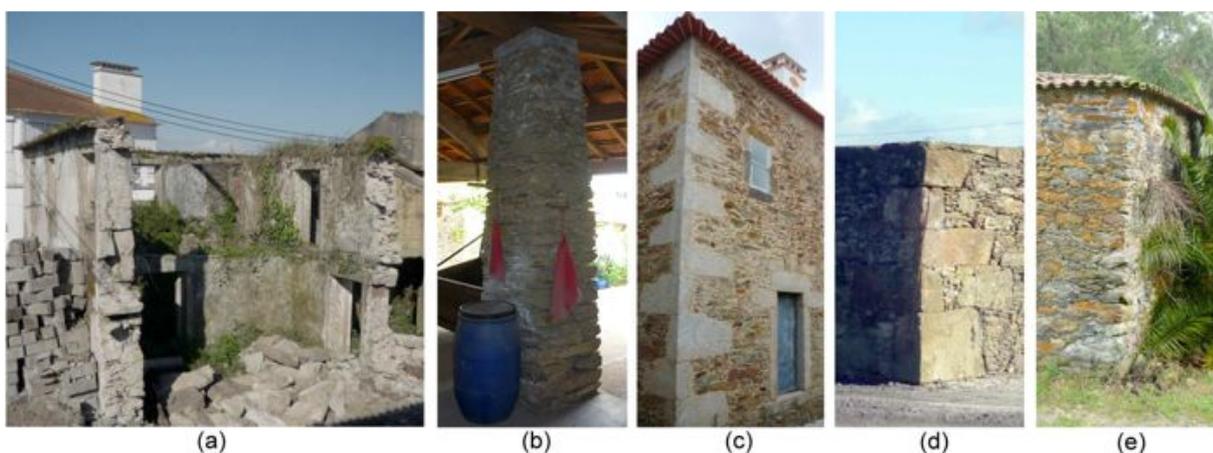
(a) Exemplo do sistema de caixa estrutural (NE3); (b) Pilar em alvenaria de xisto de suporte de cobertura de telheiro (VL2); (c) Reforço de cunhal em cantaria de granito (TR7); (d) Reforço de cunhal em cantaria de xisto (TH); (e) Reforço de cunhal com unidades de xisto de maiores dimensões (LN6)
